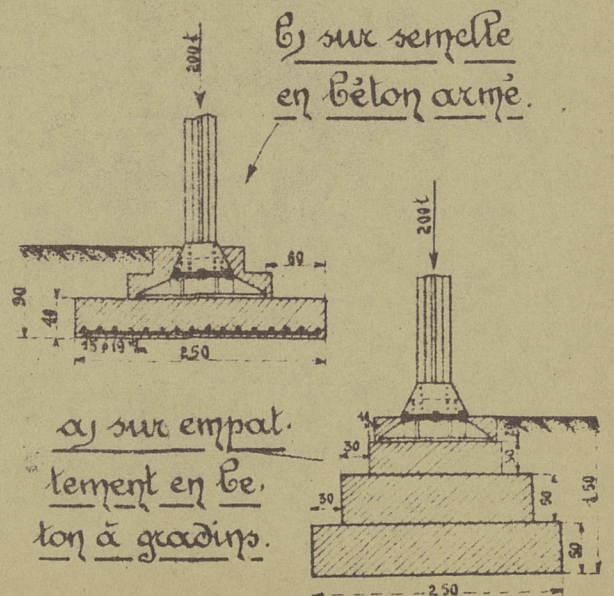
Fondation d'une colonne métallique sur cloche considérée.
